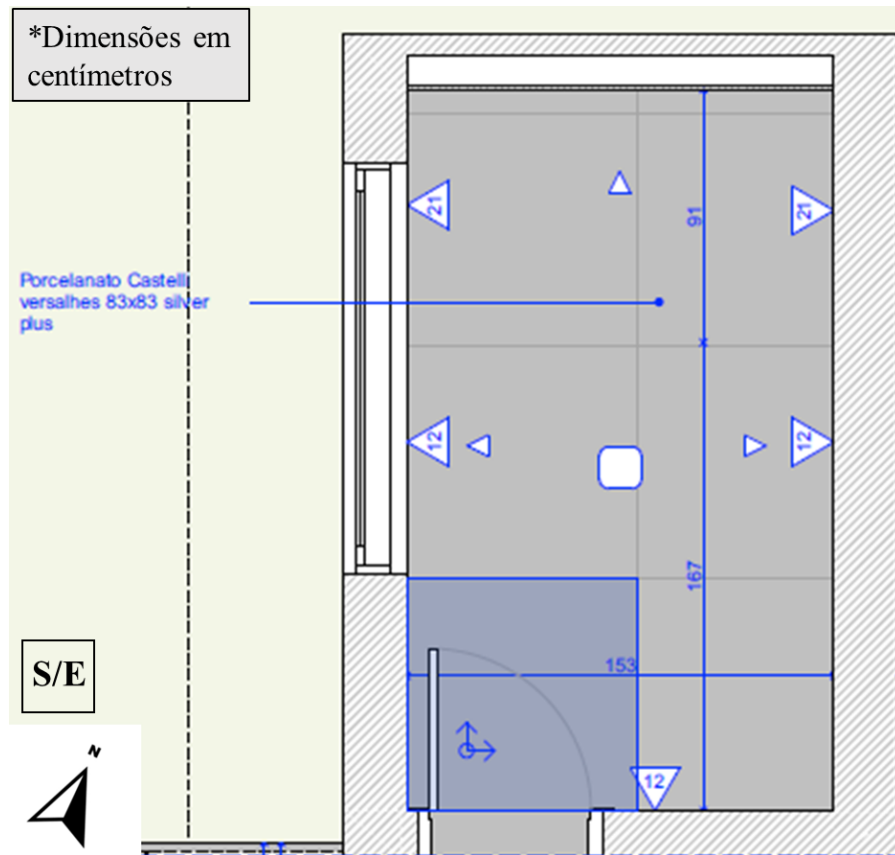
Projeto de construção do Dormitório 04 e Banheiro 07 da edificação
